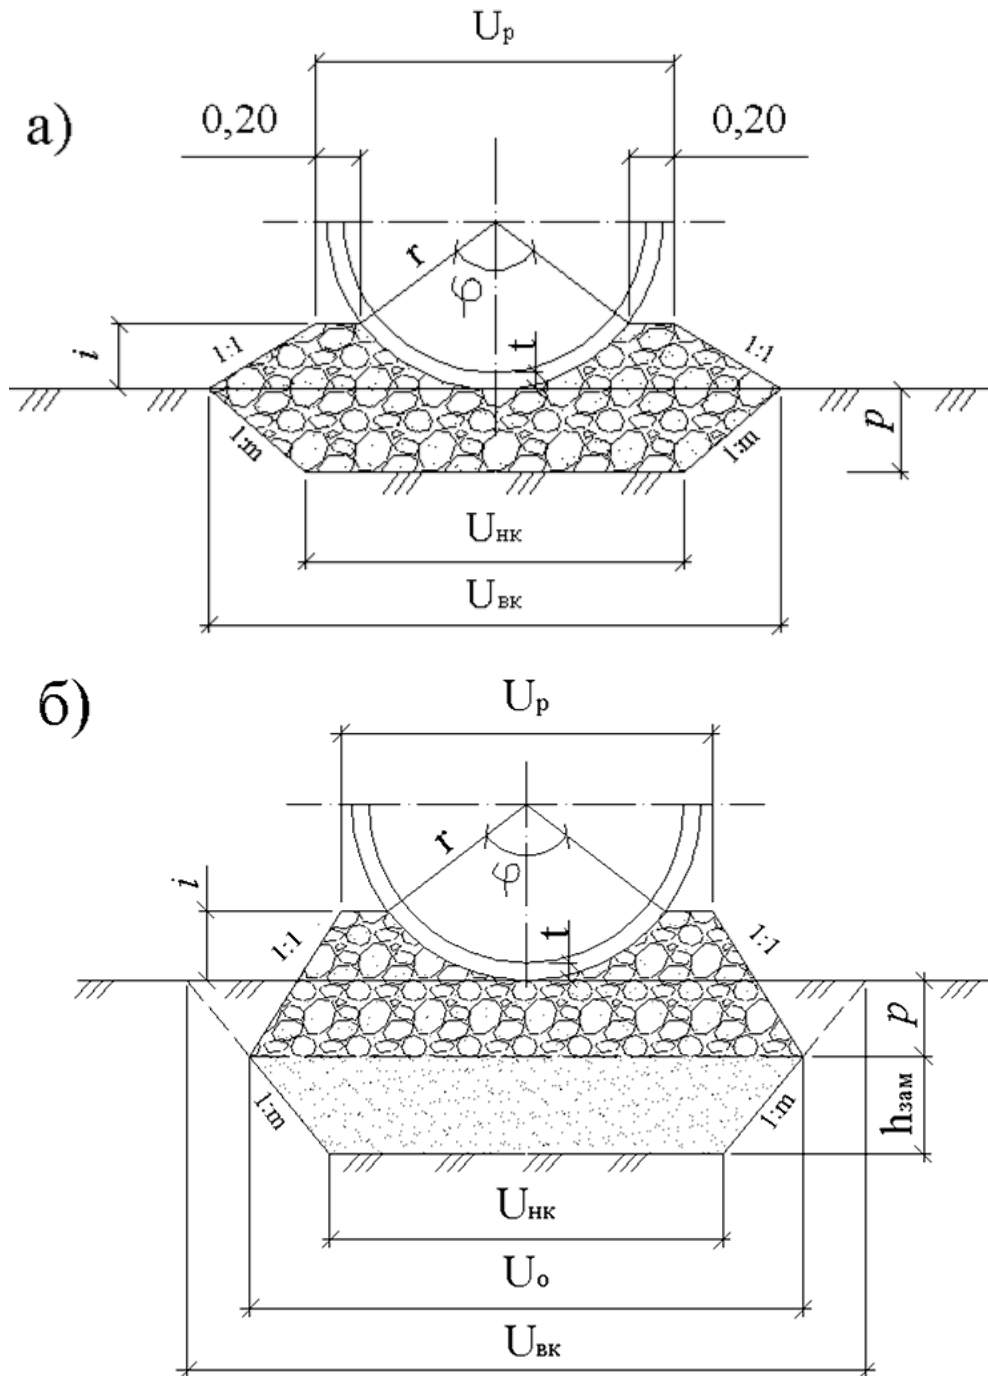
Поперечное сечение основания бесфундаментной одноочковой трубы без замены грунта под основание (а) и с заменой грунта (б)
